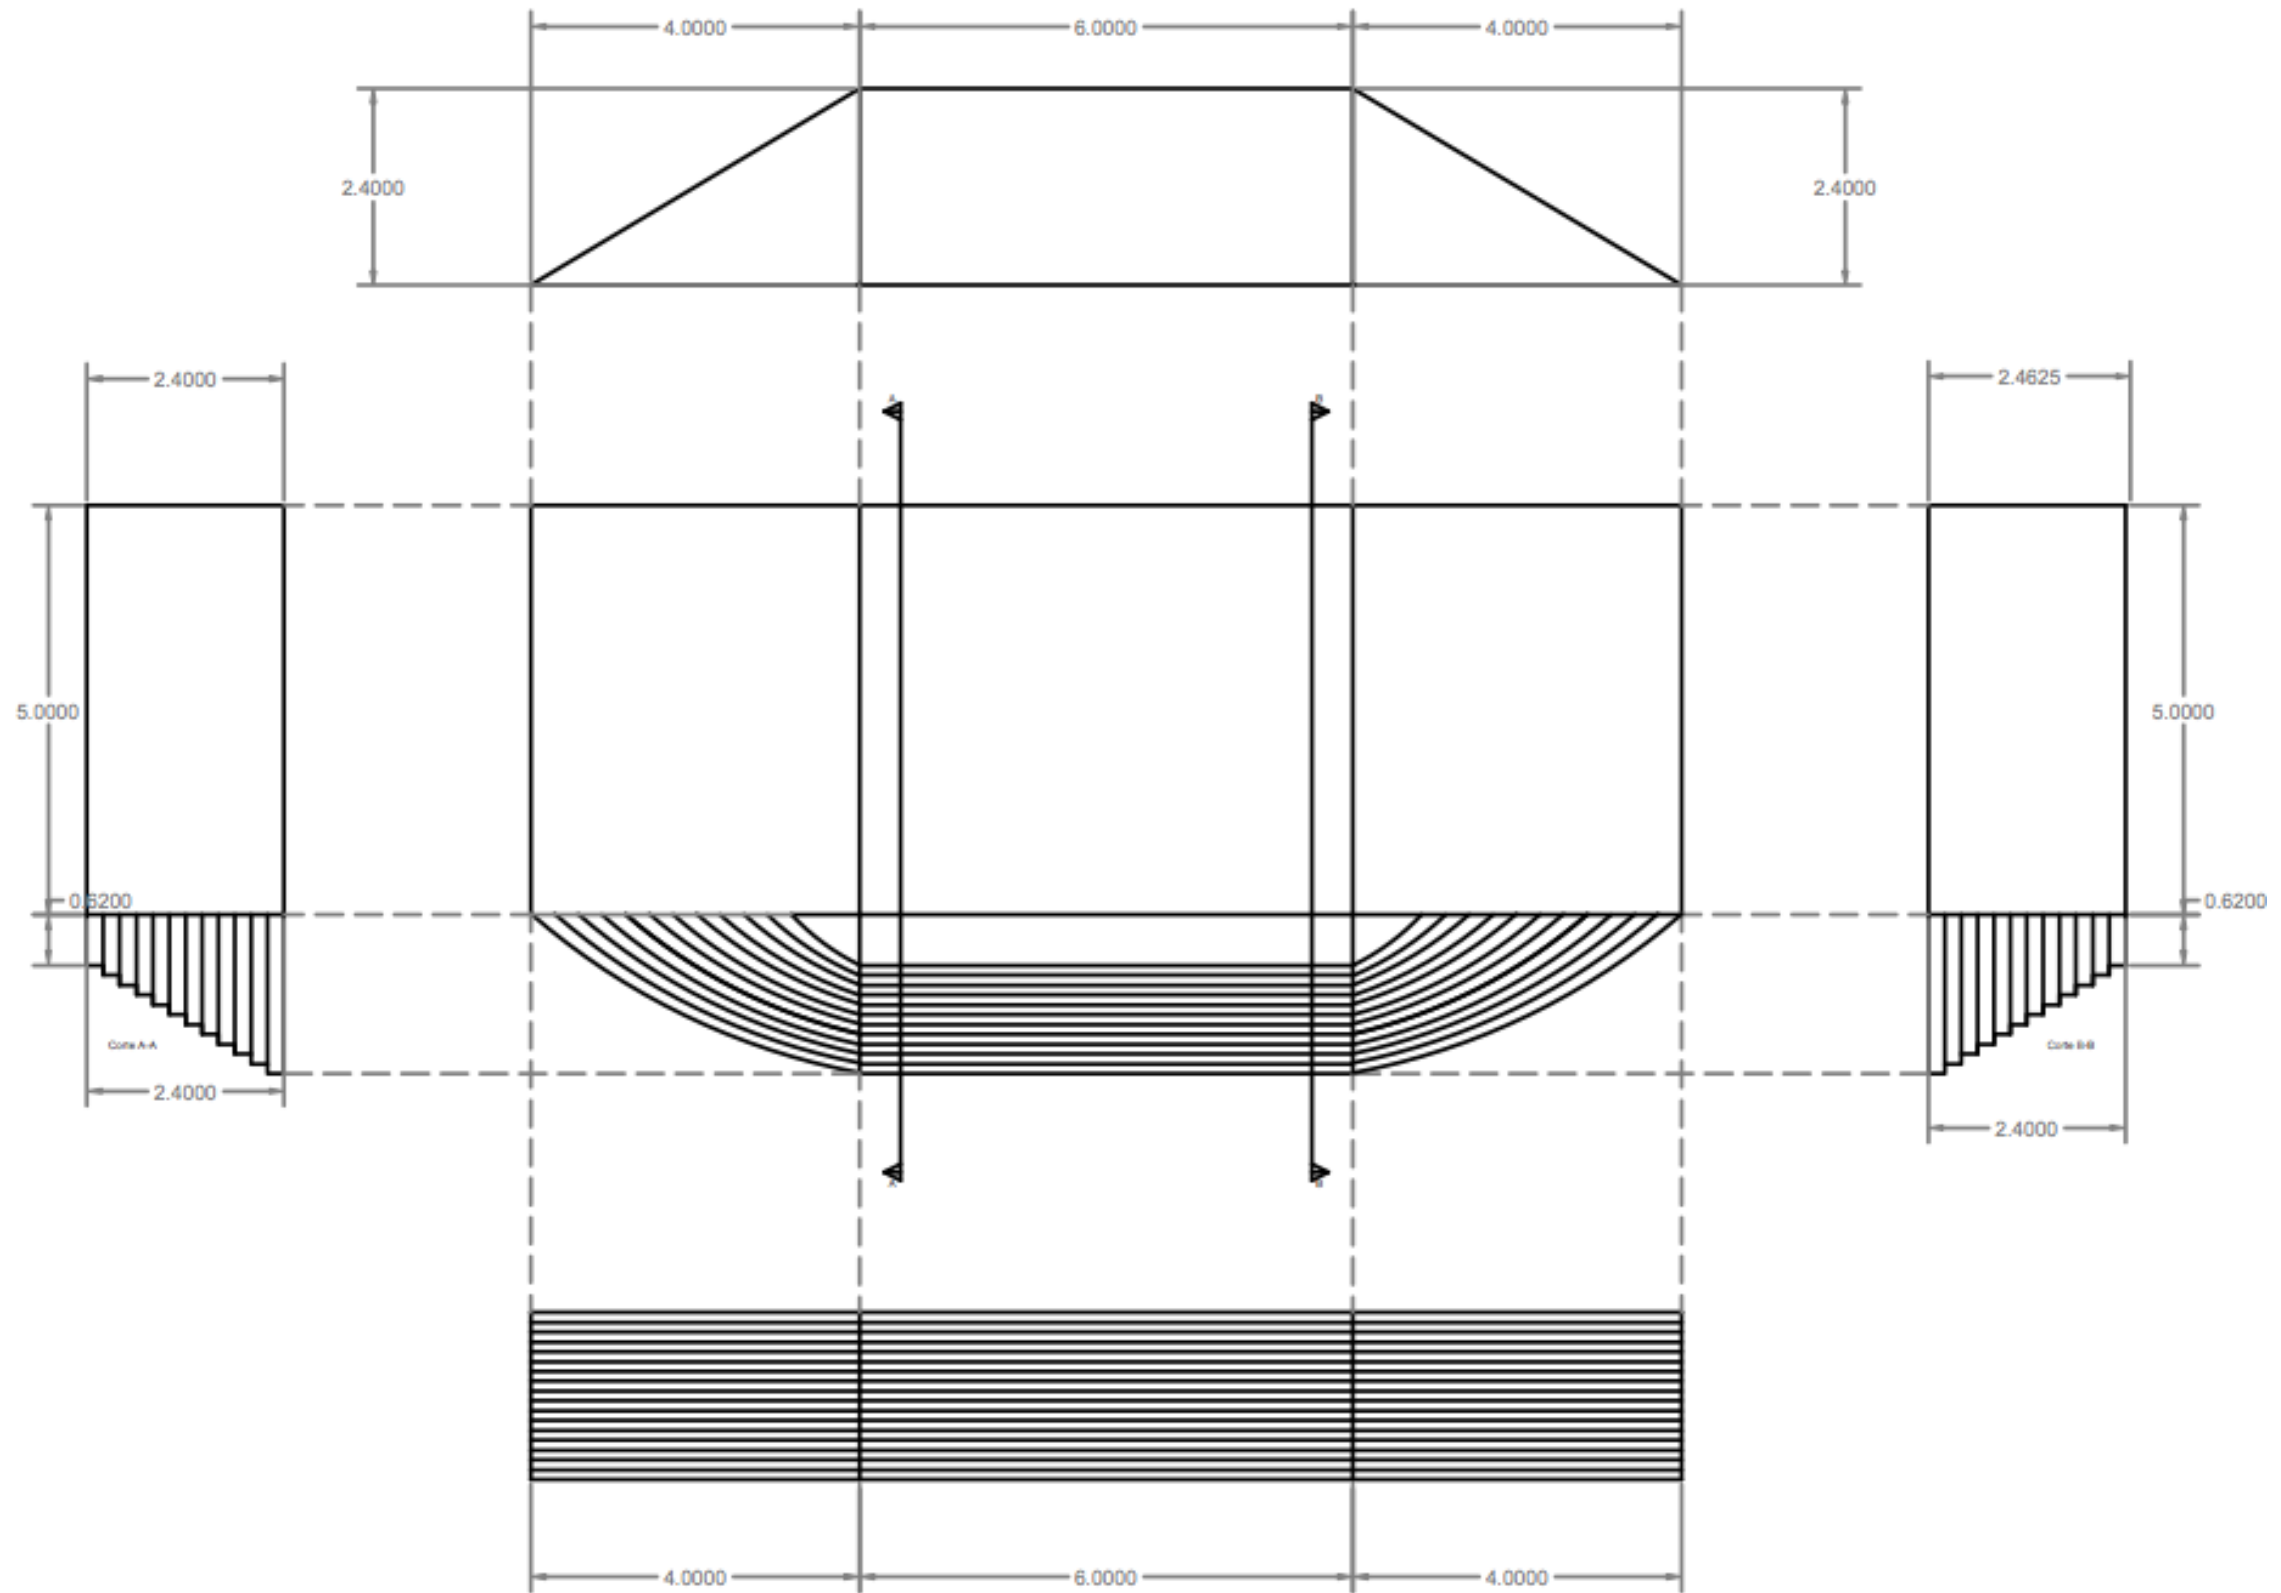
Vistas de corte, alçado e planta do protótipo.
